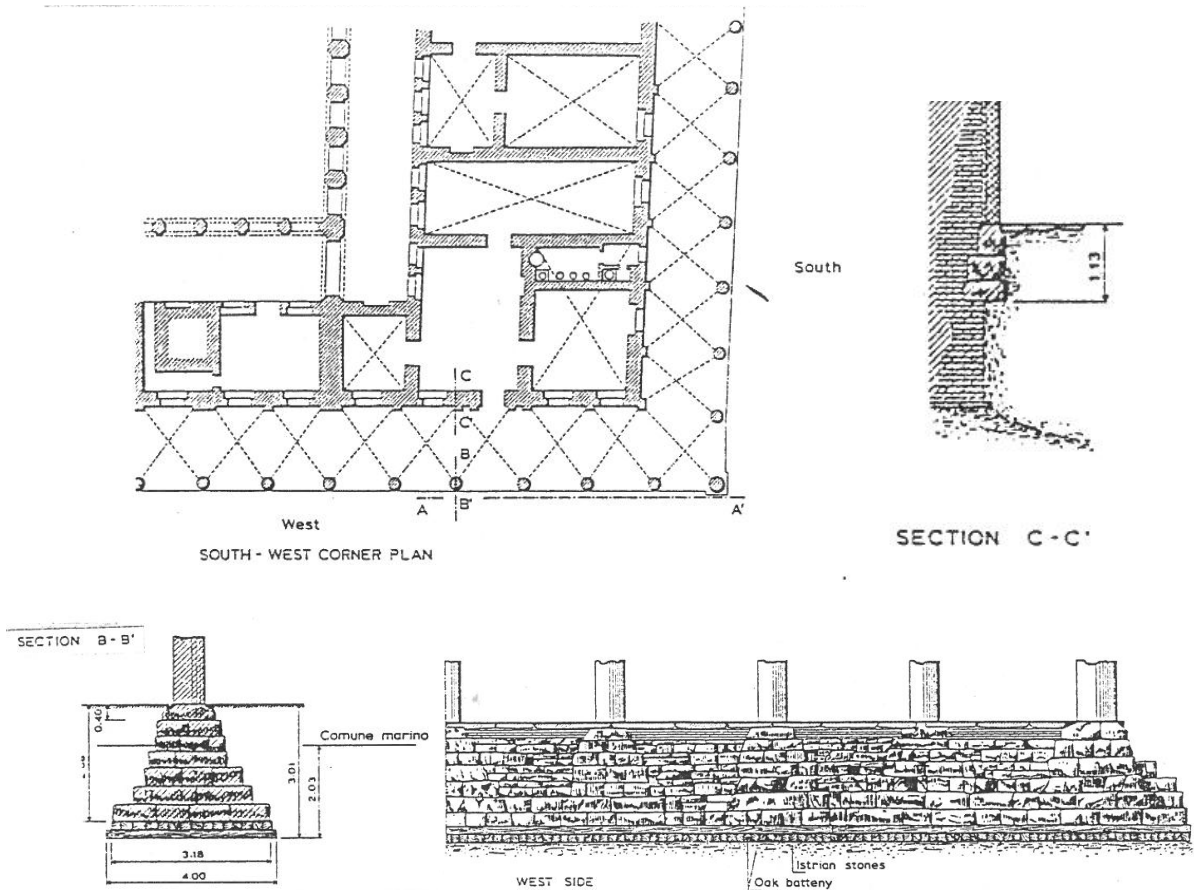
Fondazioni di Palazzo Ducale (Malvezzi, 1874)
